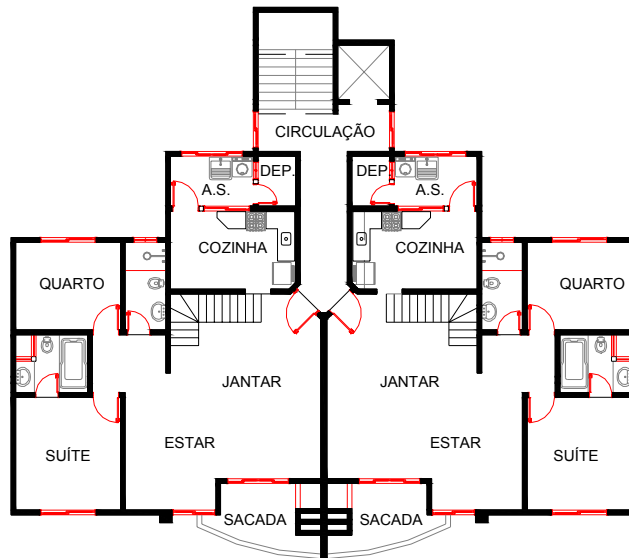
Planta Baixa do pavimento inferior da Cobertura do Estudo de caso D.
